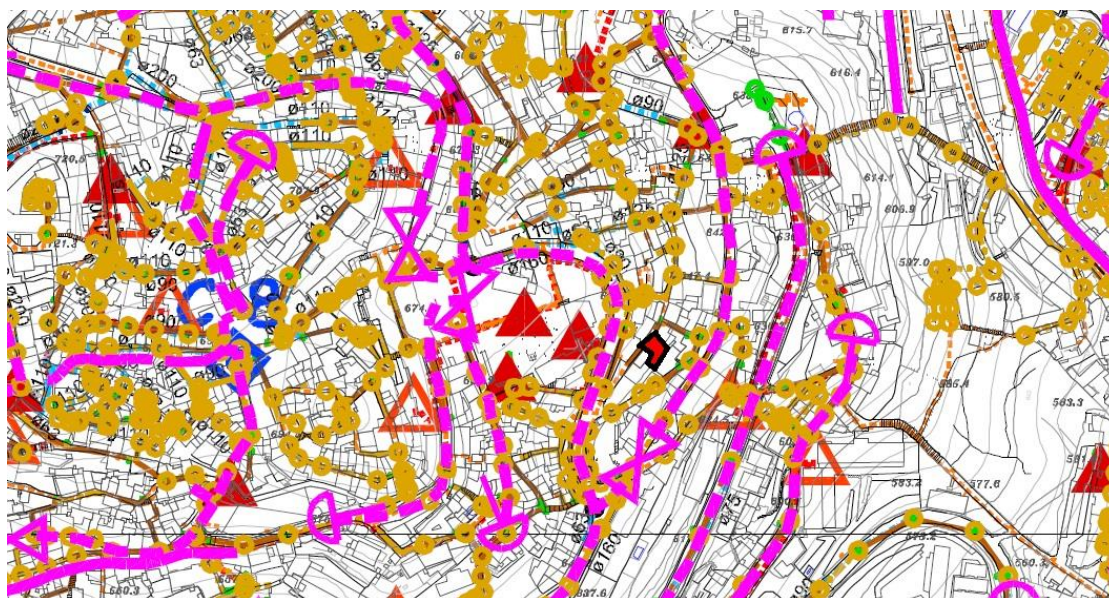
Excerto da planta de Infraestruturas básicas - PUGC, 2010
